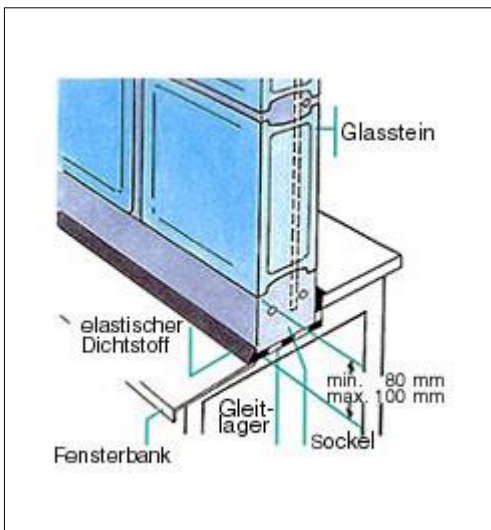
Detall constructiu vertical d'una façana construïda amb vidre pavès.
